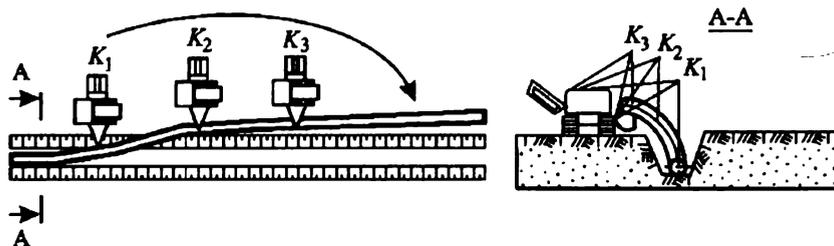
Схема укладки изолированного трубопровода в траншею
